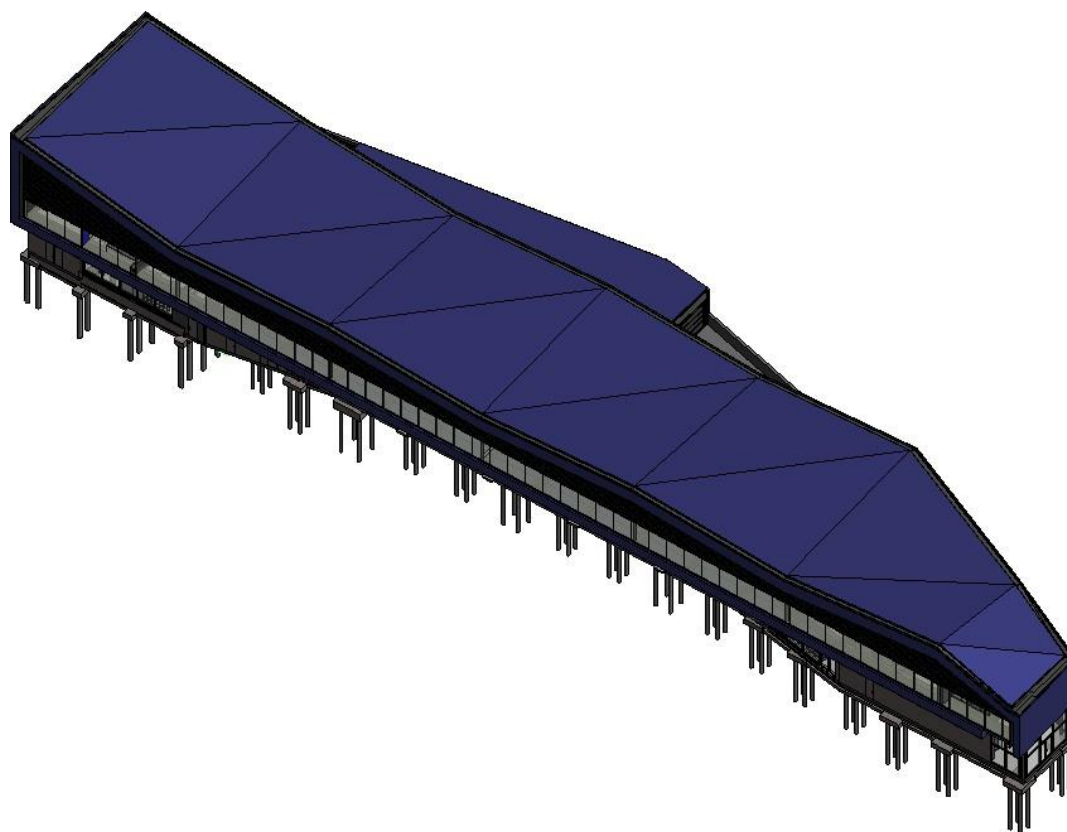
Detalle de la cubierta con canalones ocultos.
